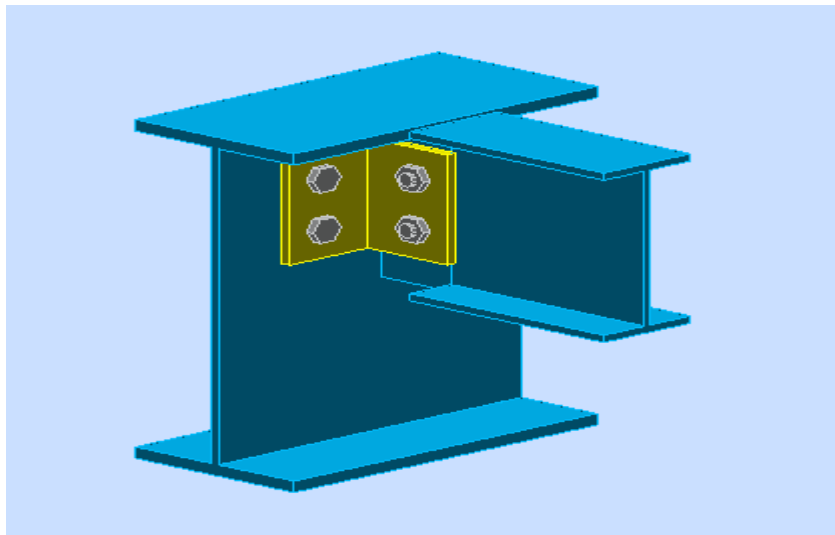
Vue en 3D de l'assemblage solive-poutre
